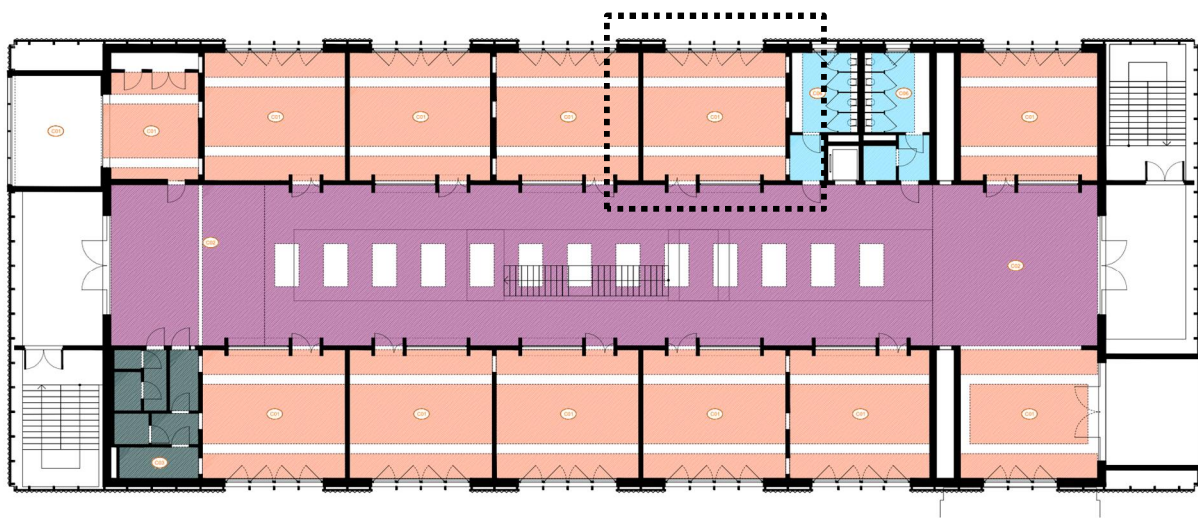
Pianta piano secondo con indicazione dei trattamenti acustici dei laboratori (rettangolo nero tratteggiato)
